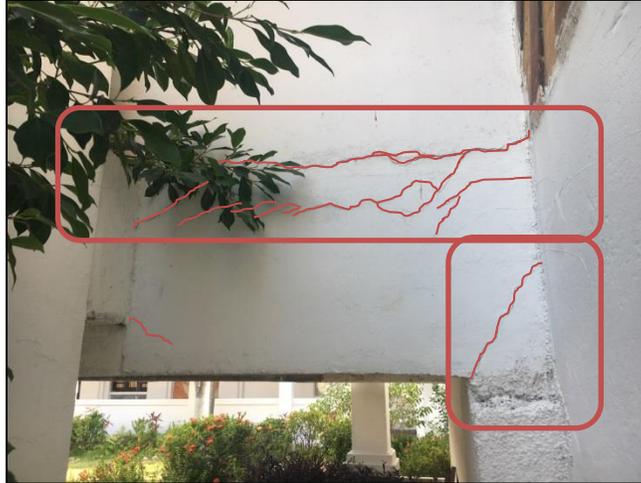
Teatro Zona Lobby – Muros Exteriores Fisurados.
